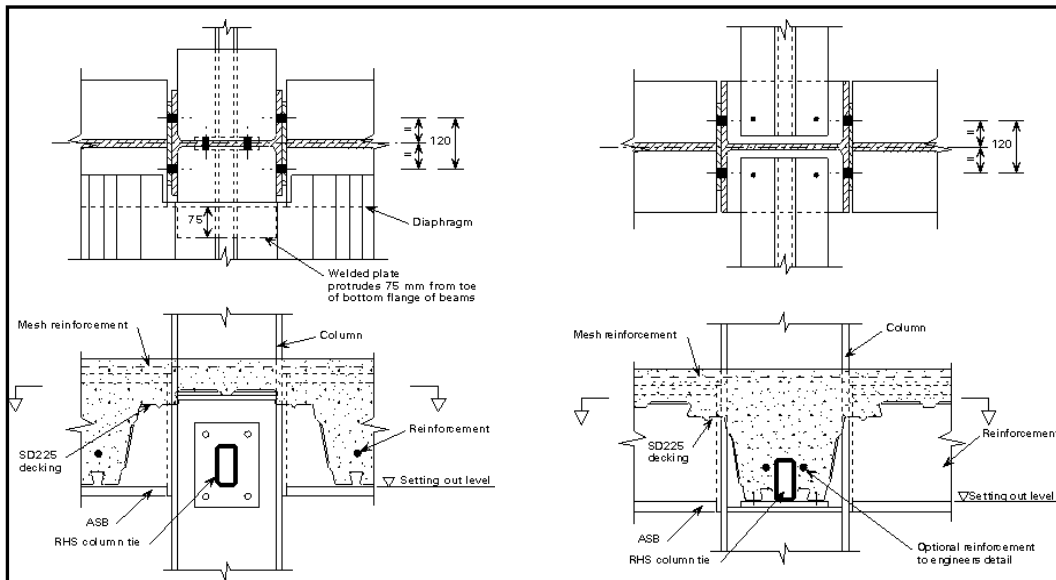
Detalhes construtivos para elementos de travamento de seção tubular
